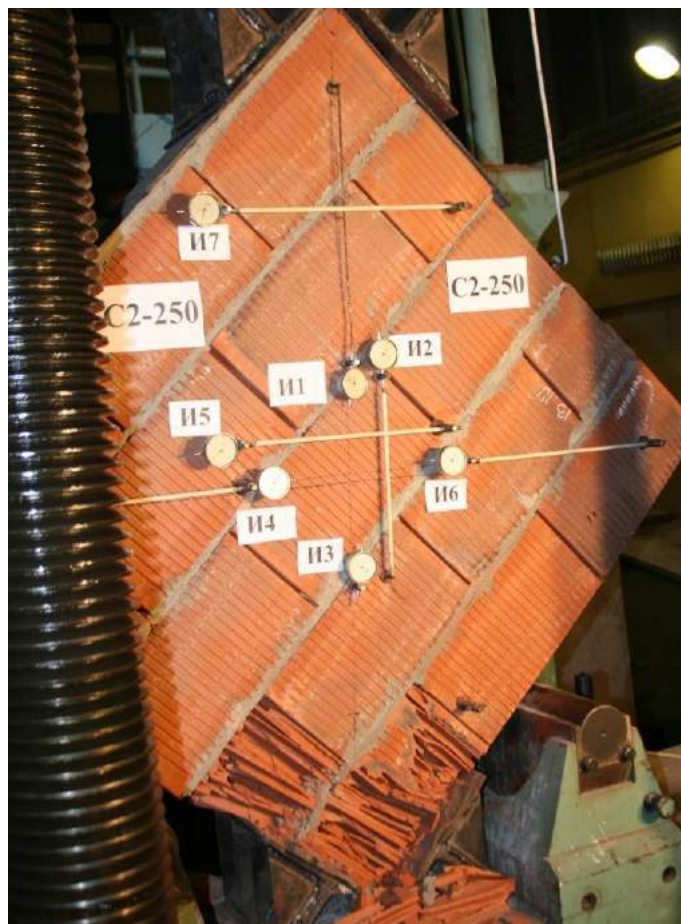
Разрушение образца С2-250. Общий вид в прессе
